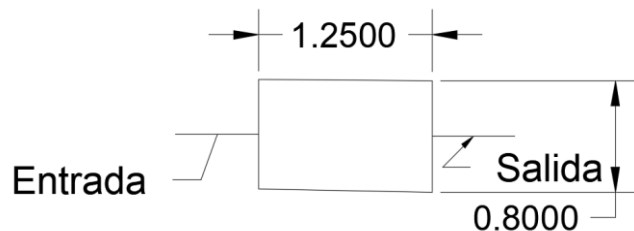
Pre dimensionamiento del filtro (planta) unidades en m
